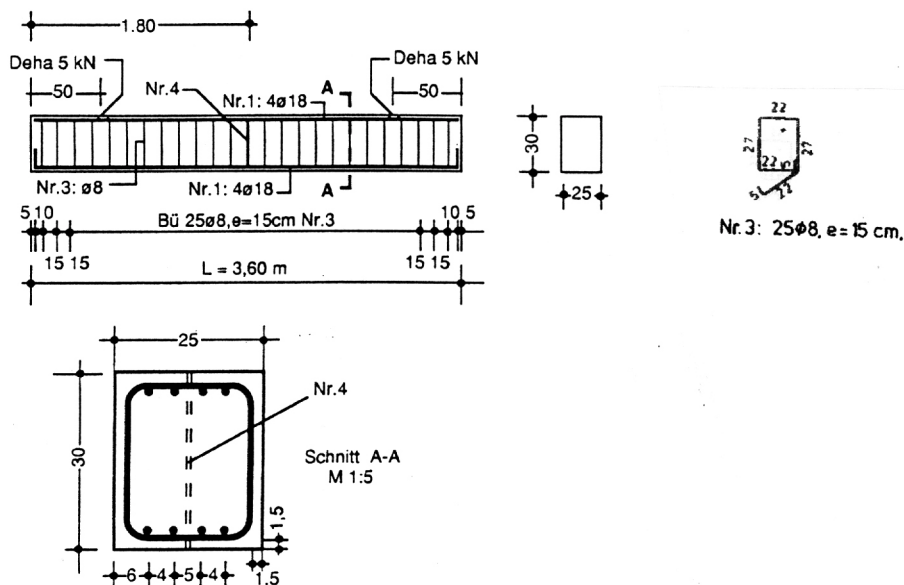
Bewehrung des Stahlbetonbalkens Versuch D3V107 [4-19]
